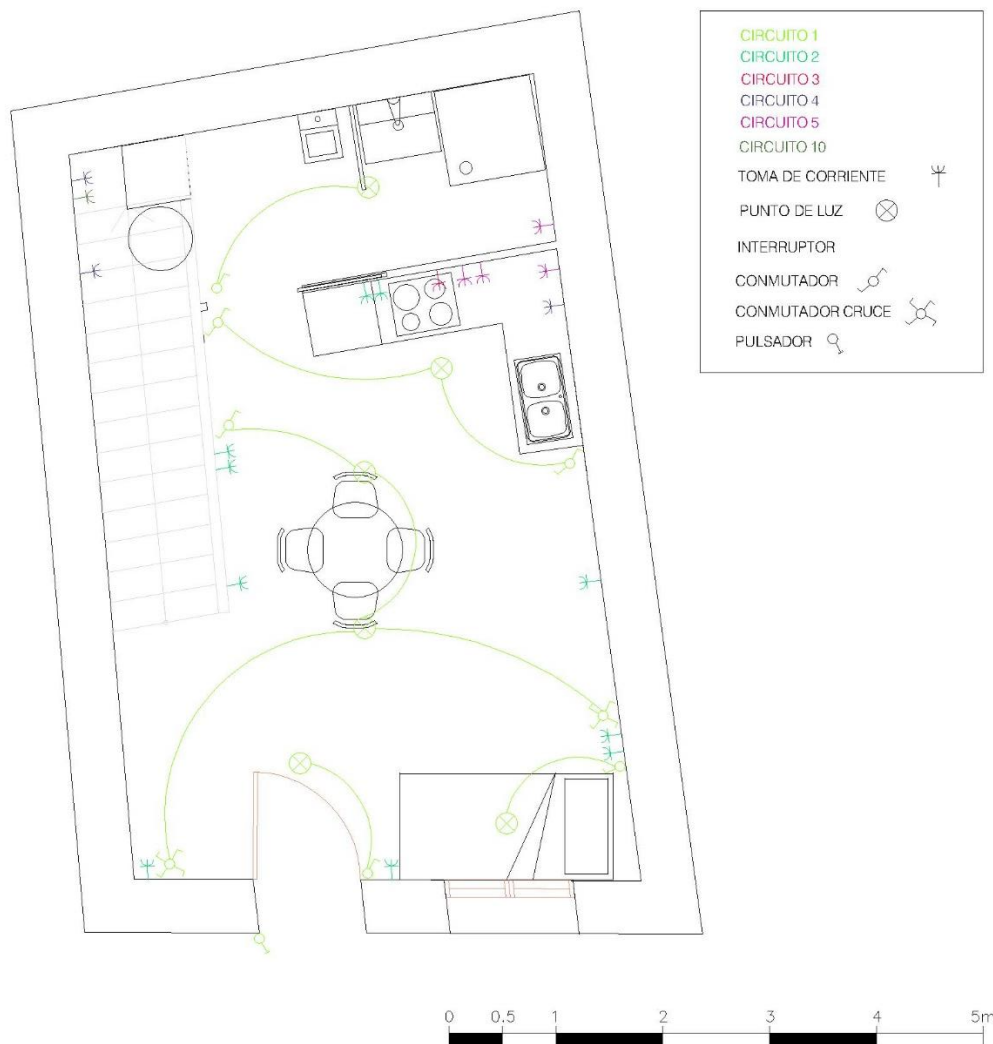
Instalación eléctrica de la vivienda tipo. Fuente: Propia
